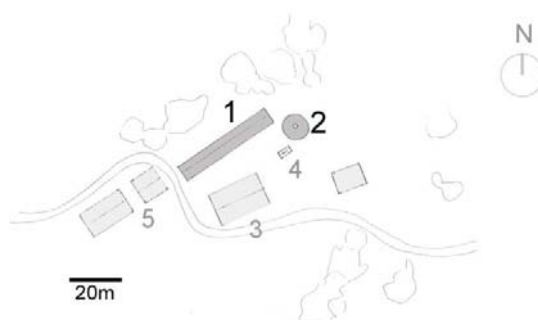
Planta de implantação do complexo de taipa/xisto em São Domingos
